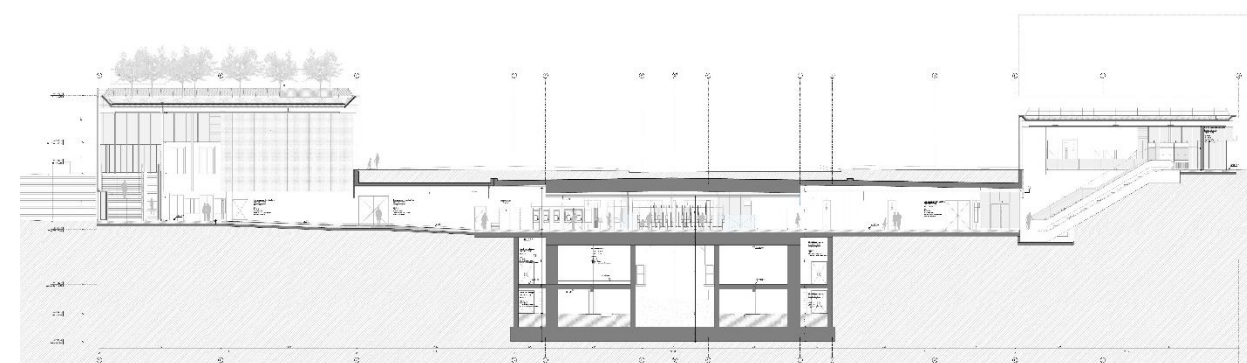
Coupe transversale du projet de la gare de Saint Quentin Est
